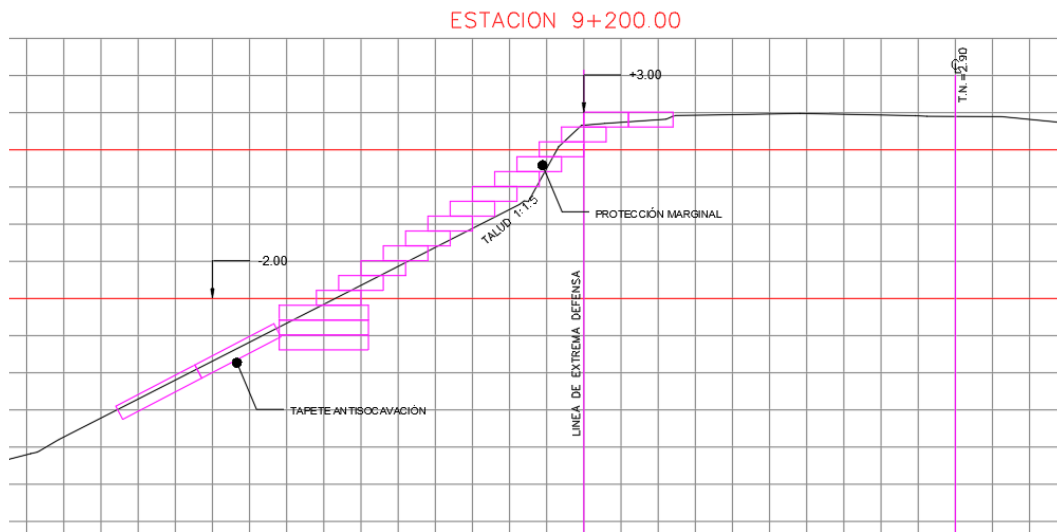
Perfil tipo de tramos donde se requiere de protección a nivel de margen actual, Alternativa 02.
